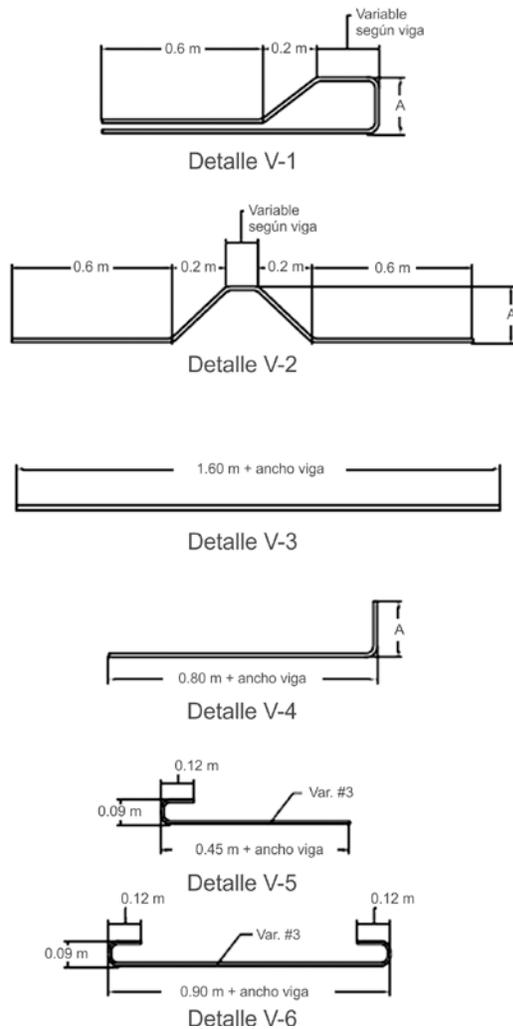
Detalles constructivos de Losa Lex (continuación)
